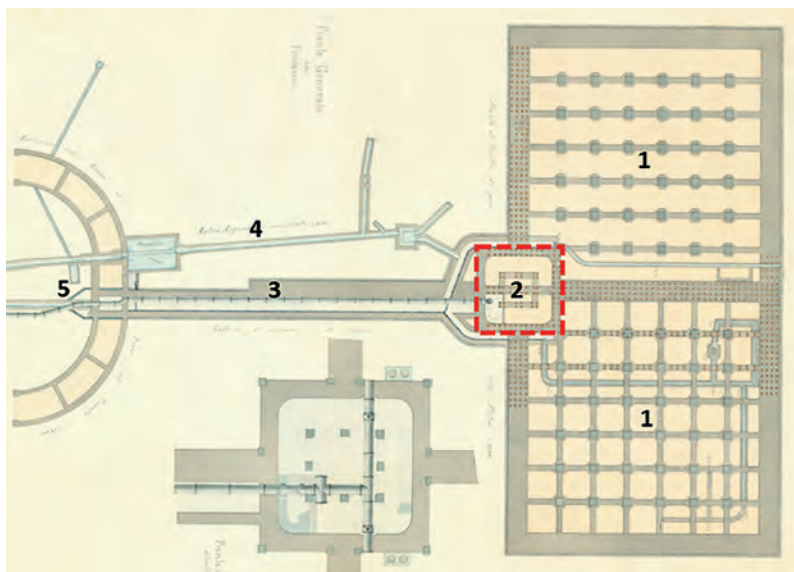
E. CORSI, *Pianta generale delle fondazioni*, 1873-1876
